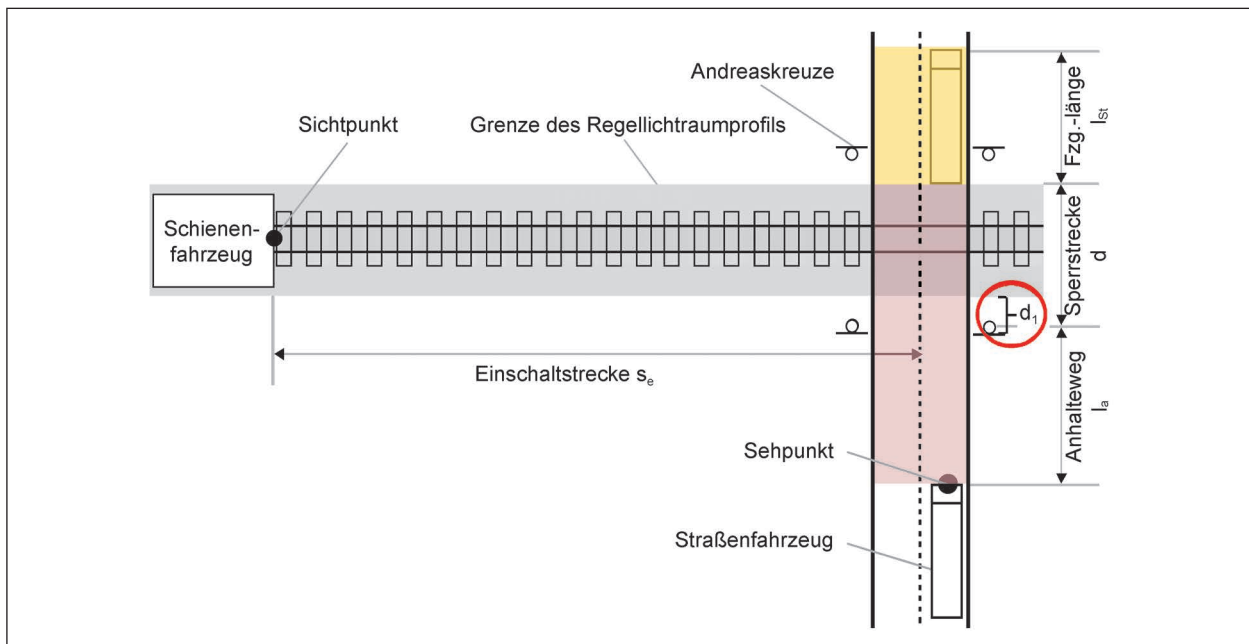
Punkte und Strecken zur Berechnung technisch gesicherter BÜ (SCHÖNE et al. 2016)
